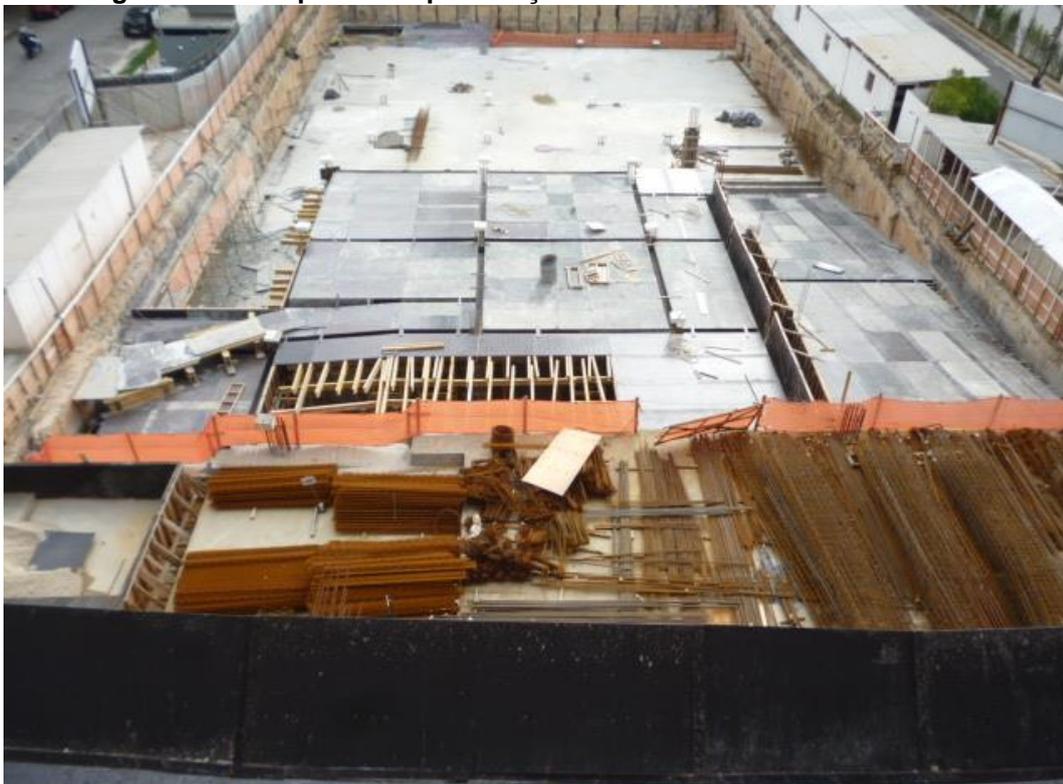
Área para estoque de aço pré-cortado e pré-dobrado e armaduras montadas - Obra SP2
